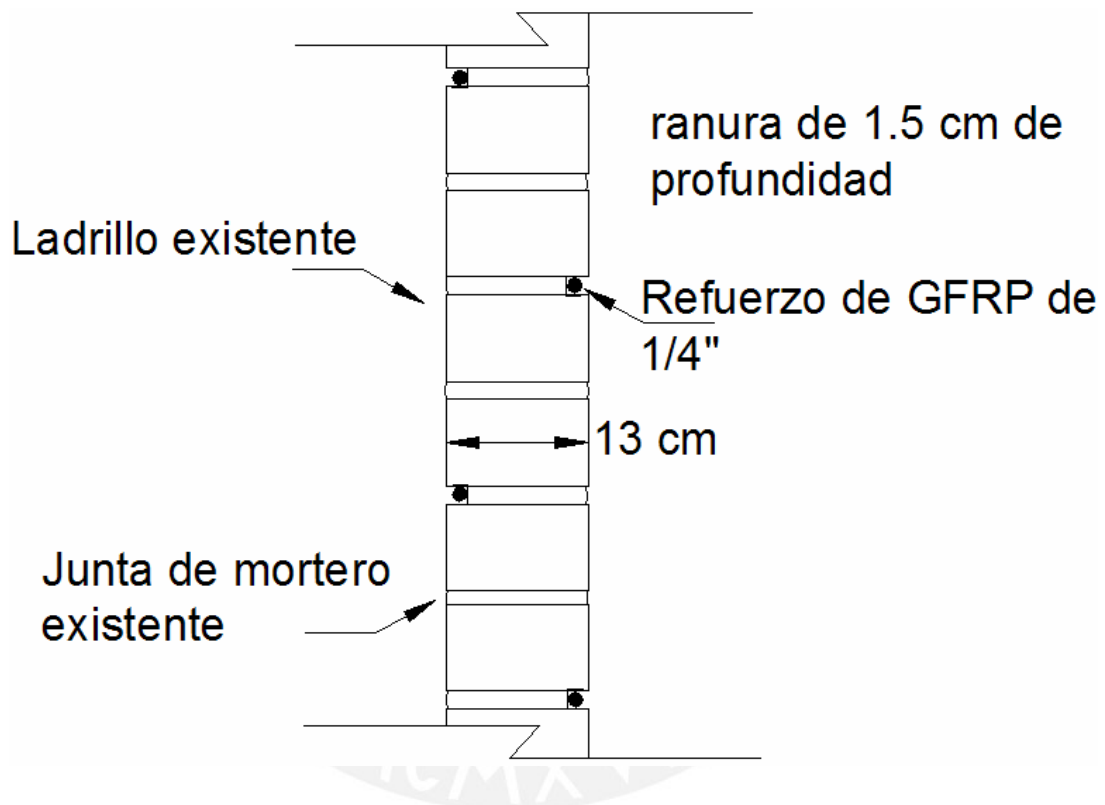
Esquema de colocación de refuerzos de fibra de vidrio GFRP. Sección vertical del muro.
